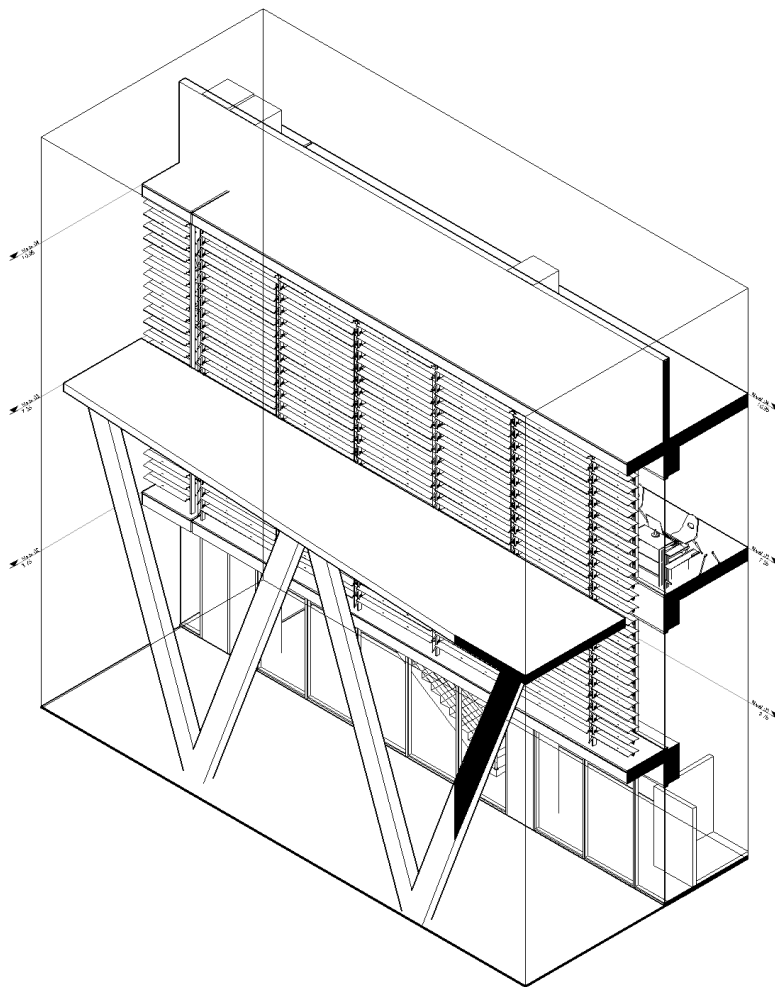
Detalle de quiebravistas. Fuente: elaboración propia
